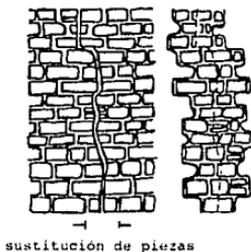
Sustitución de materiales en muros de mampostería.
